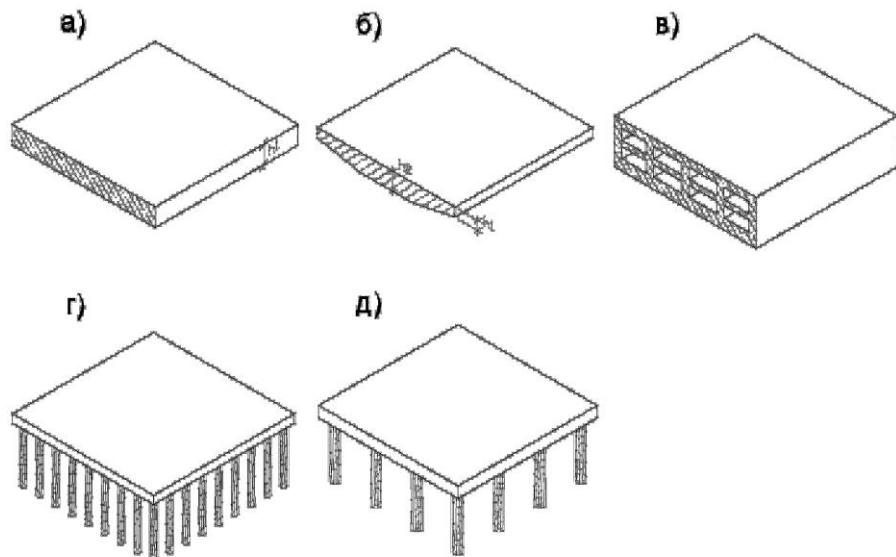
Конструктивные типы фундаментов высотных зданий:
